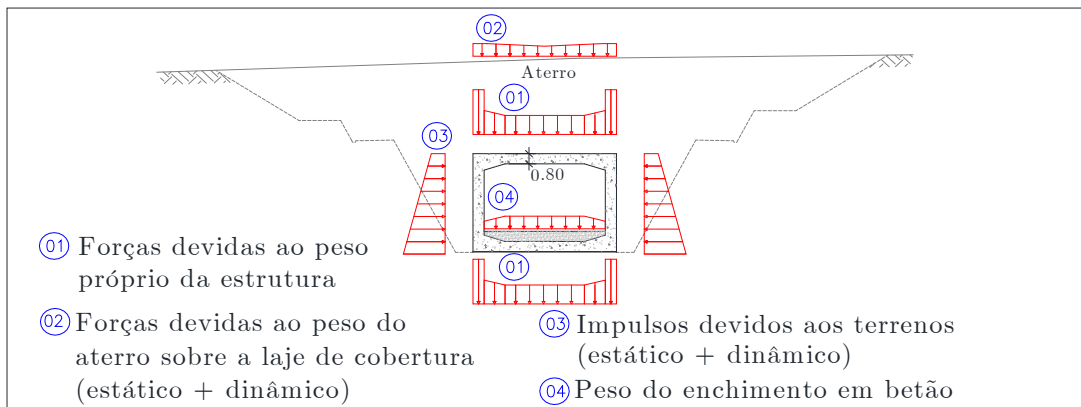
Caso de Carga 3 – Secção com laje de 0,80m situada entre taludes de escavação.
